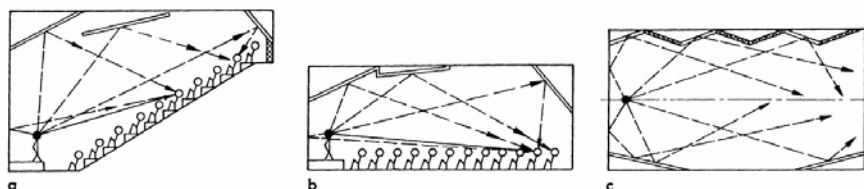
Nützliche Reflexionen für den hinteren Raumbereich (a und b Aufrisse, c Grundriss)
